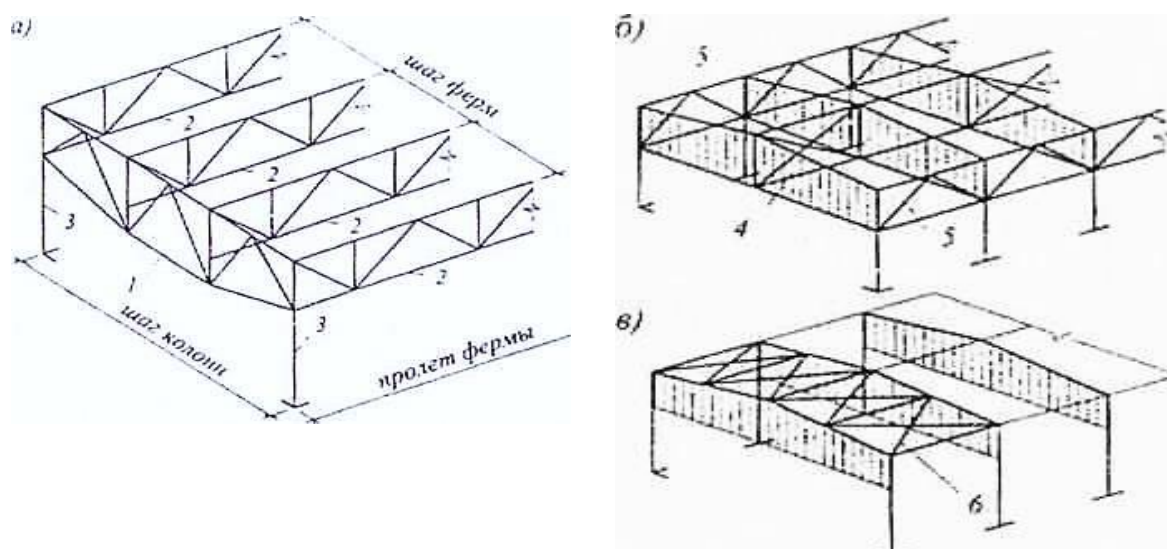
Схема стропильного покрытия и система связей:
